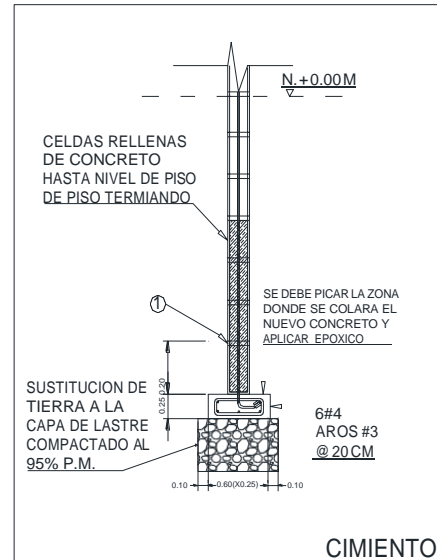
ZONA DE PERFORACIÓN EN MAMPOSTERÍA.
